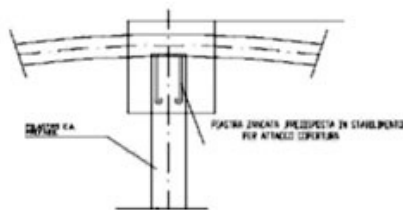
Aggancio delle travi in legno lamellare con i pilastri in mezzeria.
